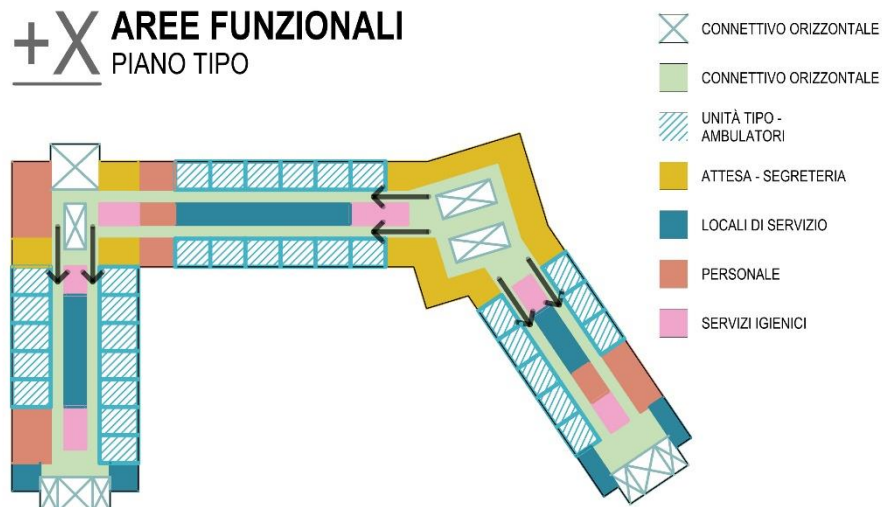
Pianta del piano tipo con indicazione delle superfici e schematizzazione della possibile distribuzione funzionale
